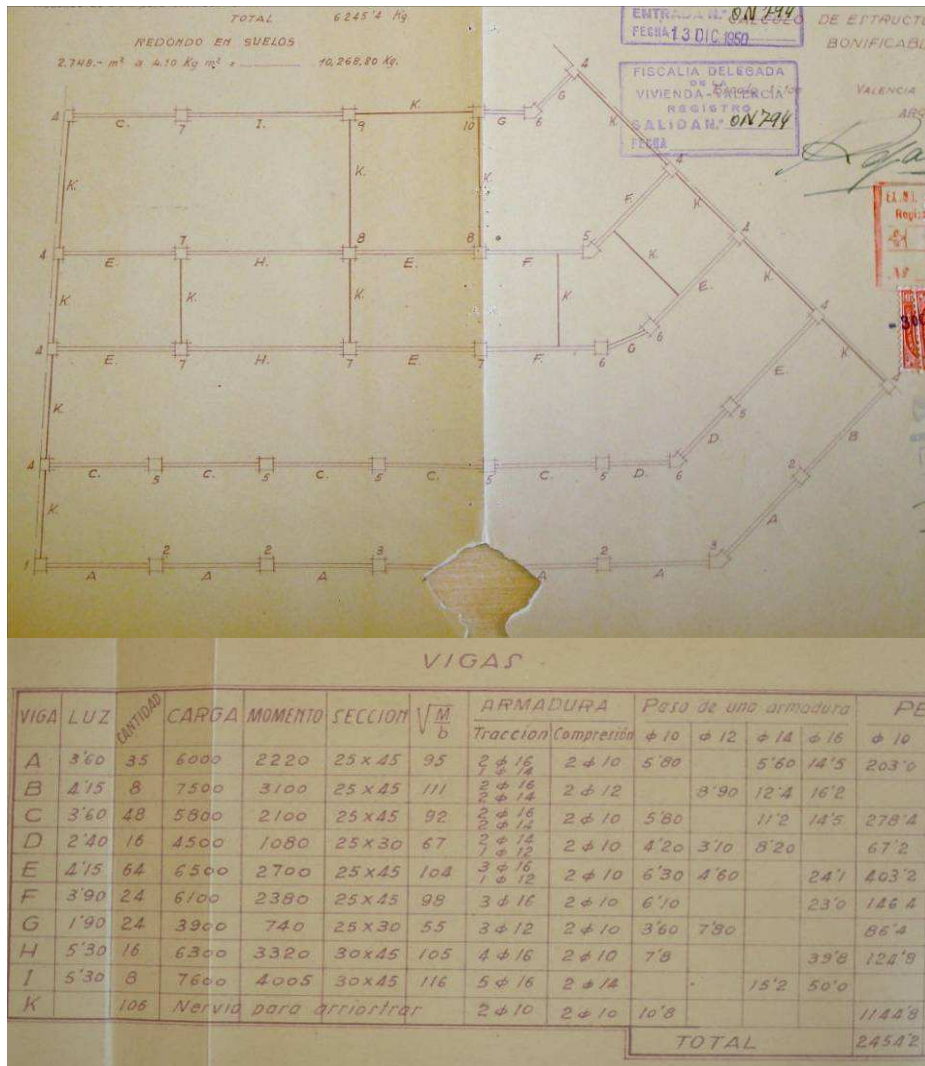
Plano de estructura de vigas. Edificio ficha 100C.007, 1949.
